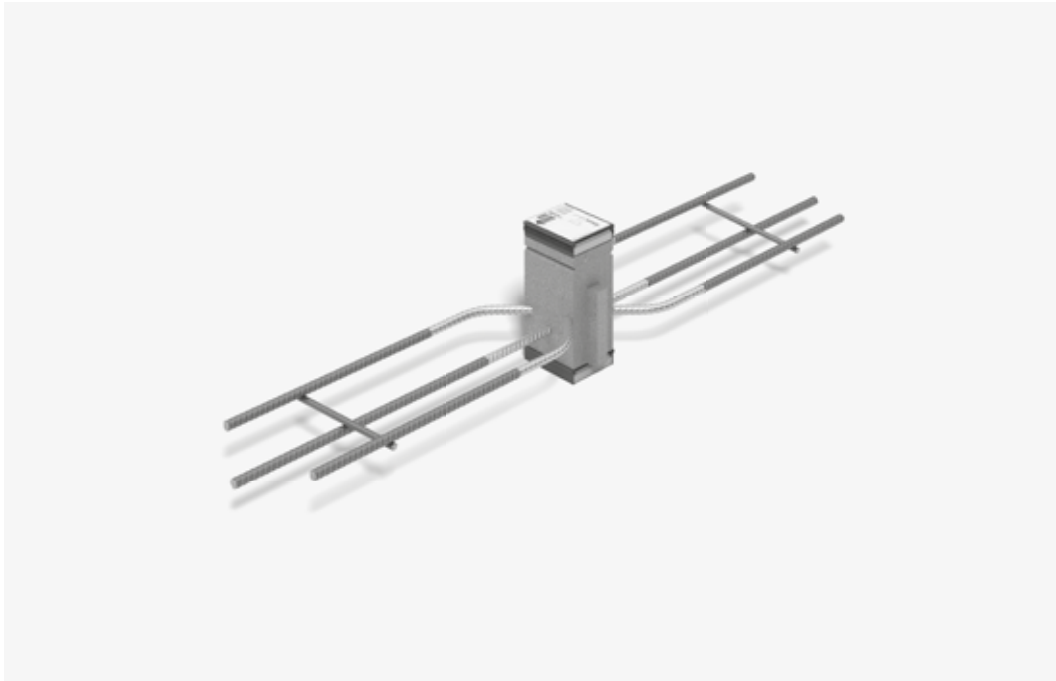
Schöck Isokorb® T typ DL: Isokorb® T typ DL zabudovaný nad filigránovou deskou
